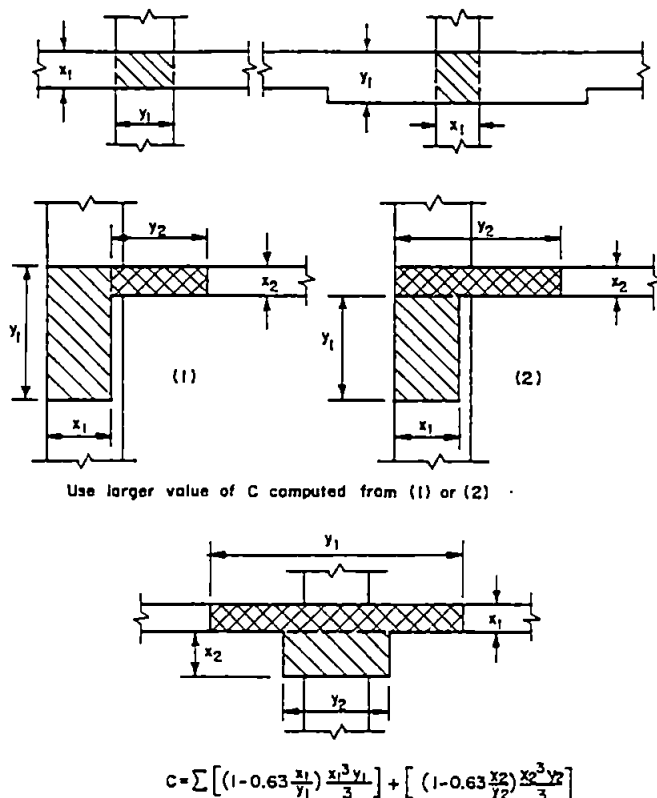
Constante de la sección transversal C, para definir las propiedades torsionales de elementos sujetos a torsión.
